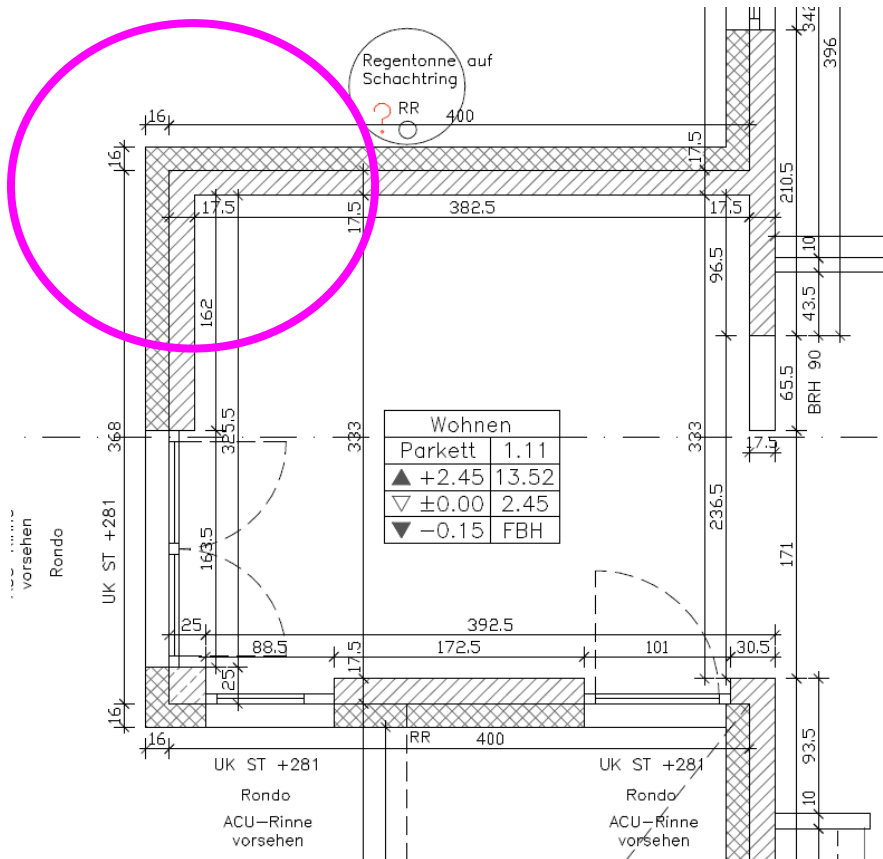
Ausschnitt aus Werkplan, Grundriss EG (OG)
